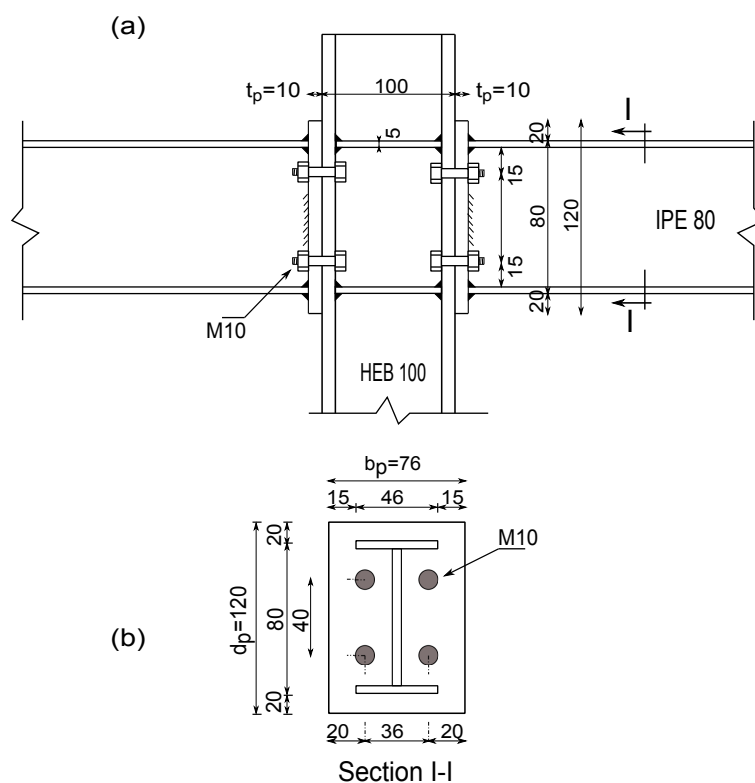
Détails de l'assemblage boulonne a plaque d'extremite (en mm)
